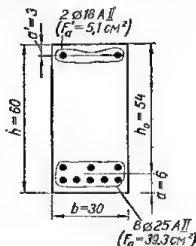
Схема-расположения арматуры в сечении изгибаемого железобетонного элемента.
